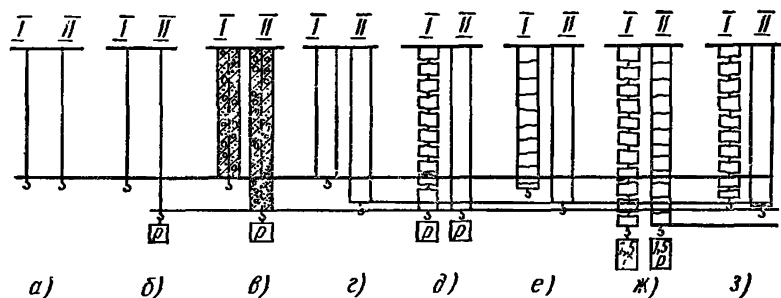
Схема работы центрально растянутых обычных и предварительно напряженных железобетонных элементов:
